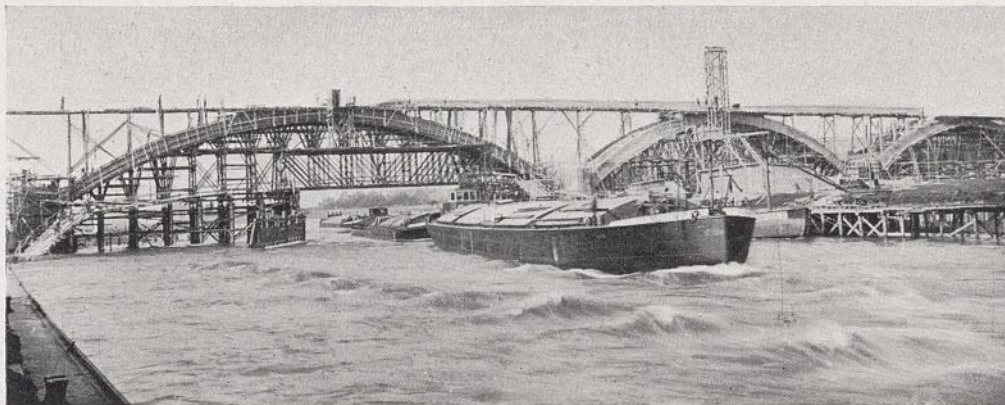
Straßenbrücke bei Vlotho, Lehrgerüst mit Schiffsdurchlaß.
